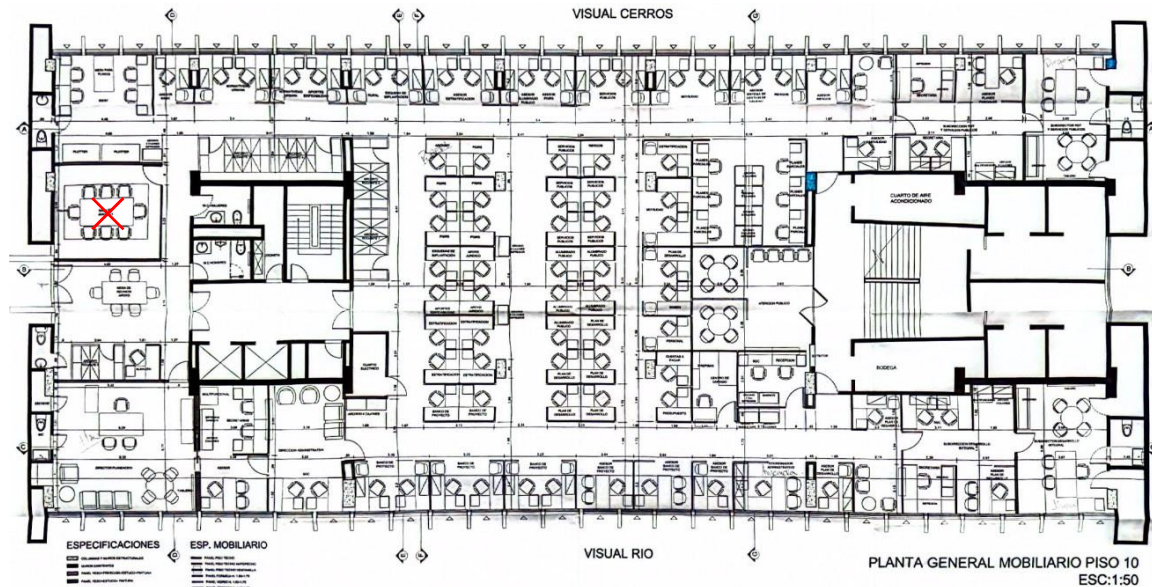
Plano del Piso 10 de la Alcaldía Distrital.
